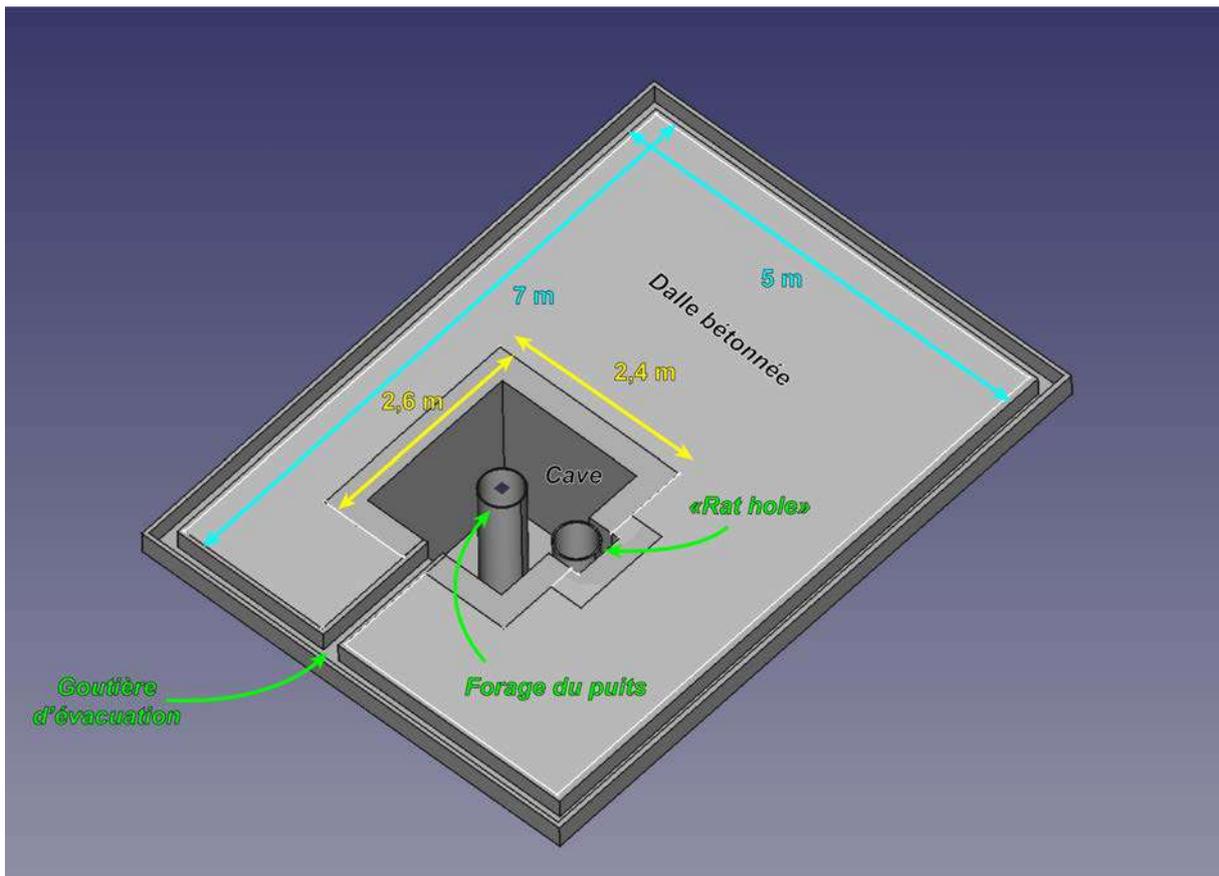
Schéma de la dalle en béton armée envisagée pour la plateforme de forage
